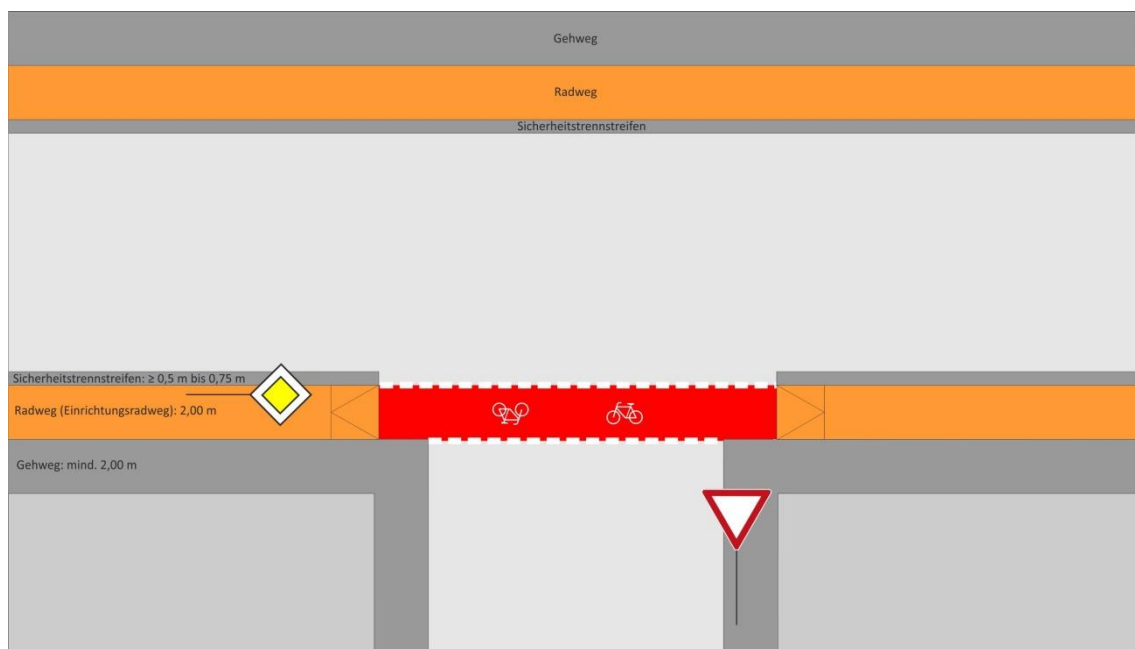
Rote Furtmarkierung an Knotenpunkten (gemäß ERA 2010, Kap. 3.4)
